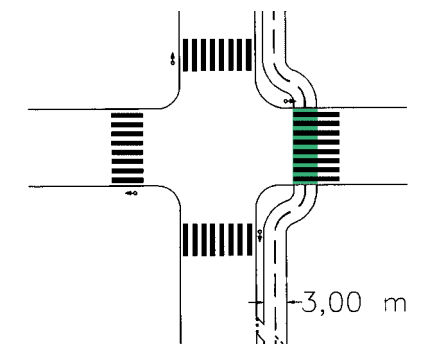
Piste cyclable bidirectionnelle sur carrefour à feux et avec descente sur chaussée pour le tourne-à-gauche des cyclistes
